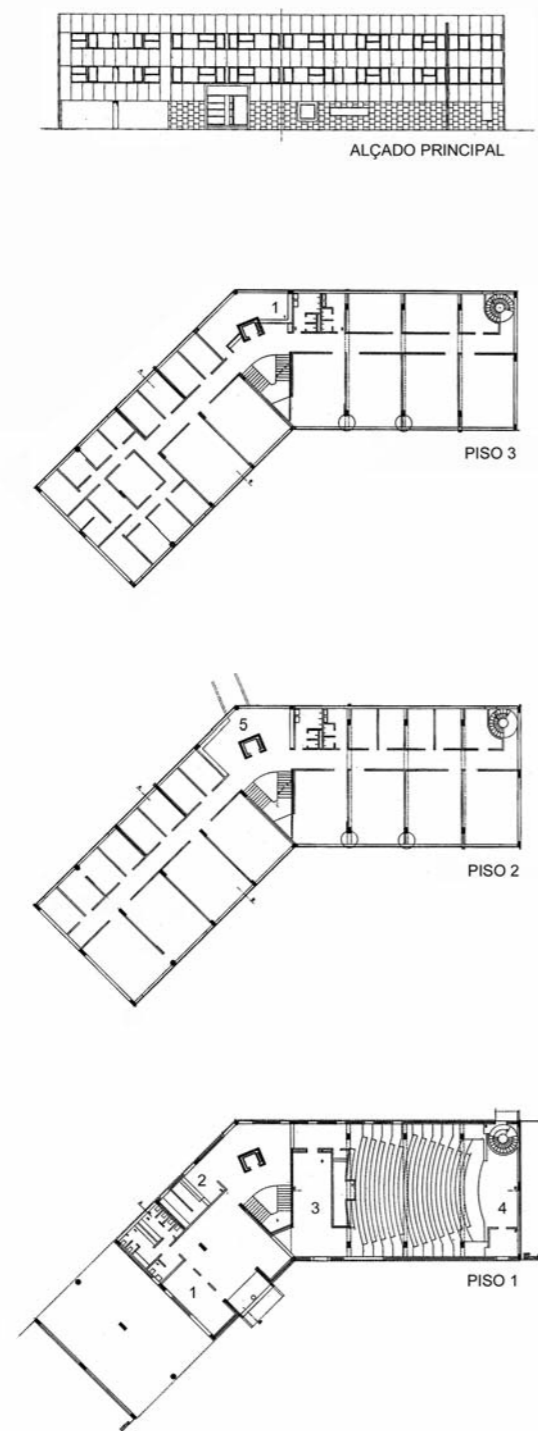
CEFA – Revisão do Projeto do *Departamento de Planeamento e Ambiente*, 1988/89. Plantas e Alçado Principal (imagens originais), escala 1/800. Legenda: 1 – Secretaria; 2 – Bar; 3 – Sala Apoio; 4 – Auditório; 5 – Zona de ligação à futura expansão. Compare-se com o projeto de Firmino Trábulo constante da figura anterior.
